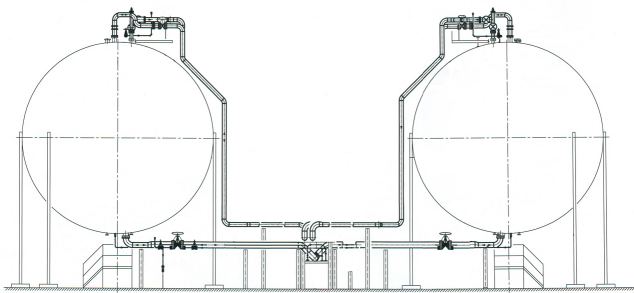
Внешний вид двух резервуаров каре Товарного парка
